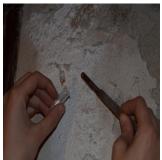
Detalle de la recogida de las muestras de sales de la parte superior del muro orientado al norte.
